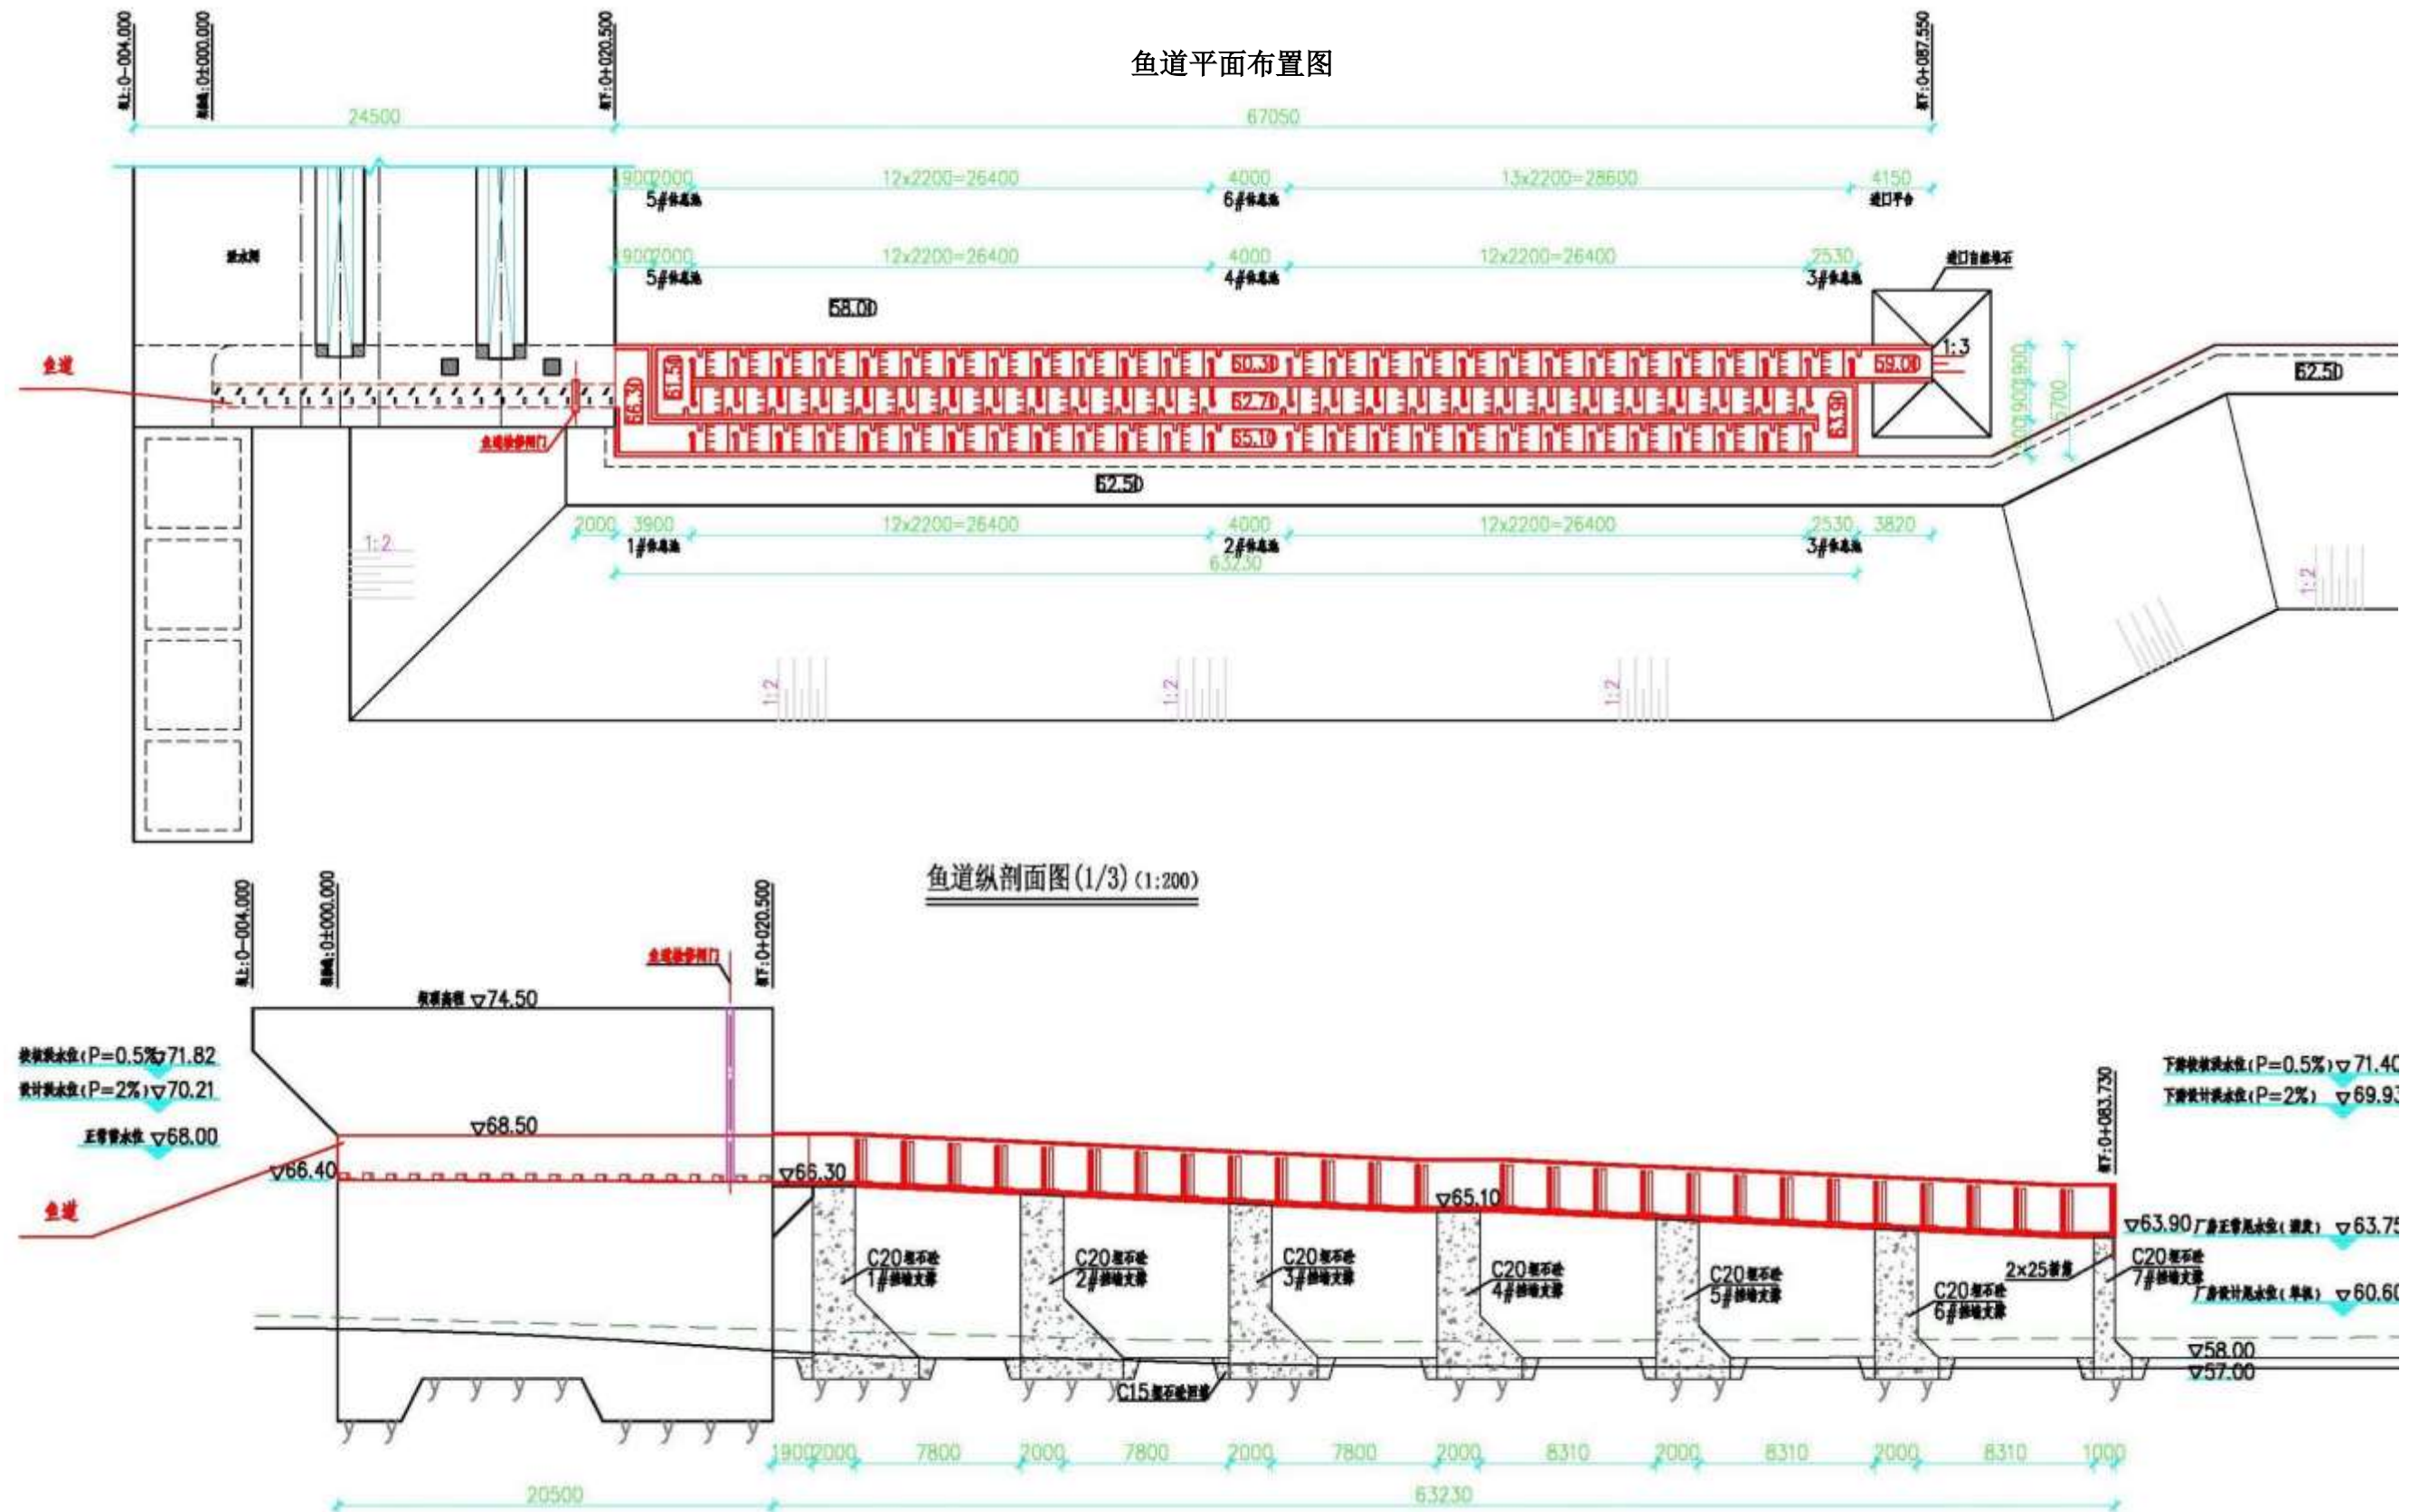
项目鱼道设计平面布置图及纵剖面图
